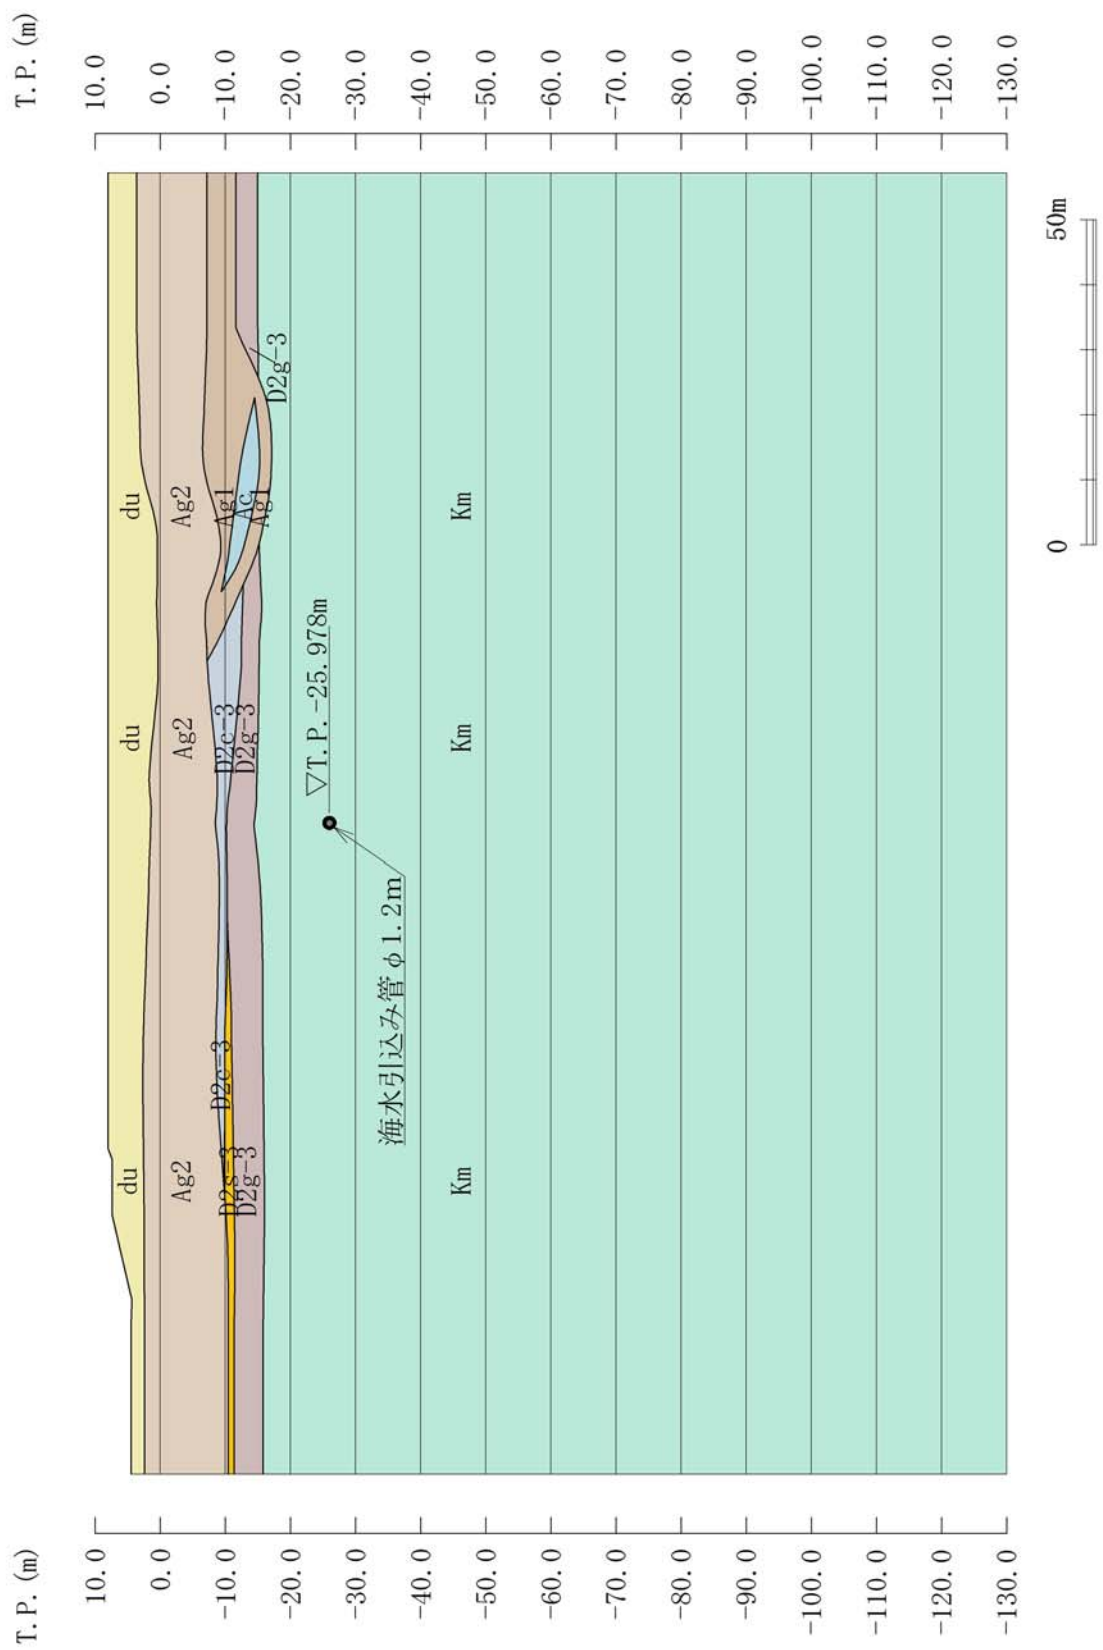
海水引込み管 横断面図 (②-②断面)
